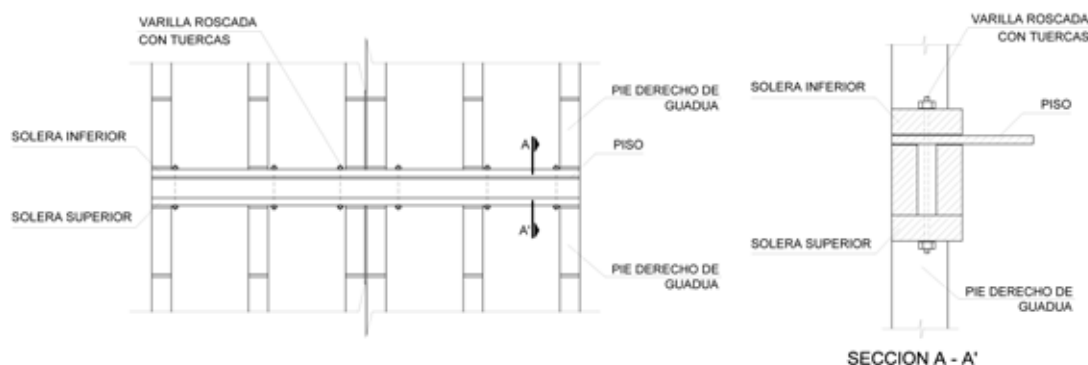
Unión muros primer piso con muros del segundo piso.
